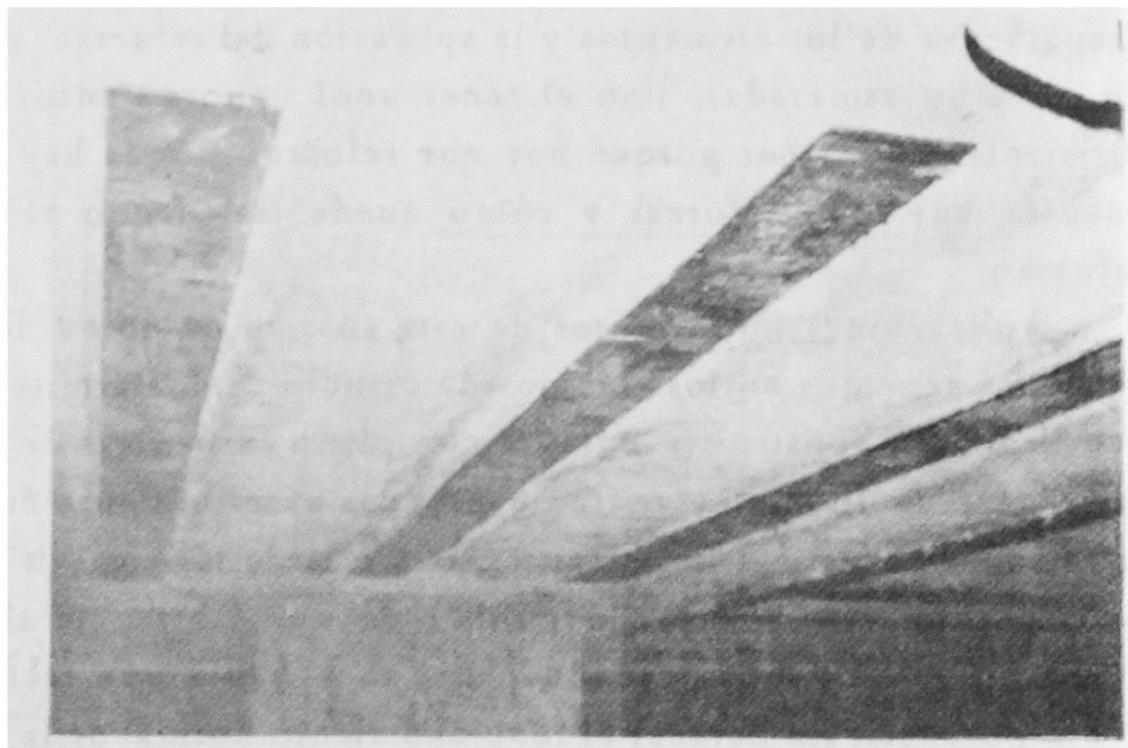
Bandas de acero unidas a una placa de piso mediante resinas epoxi.
